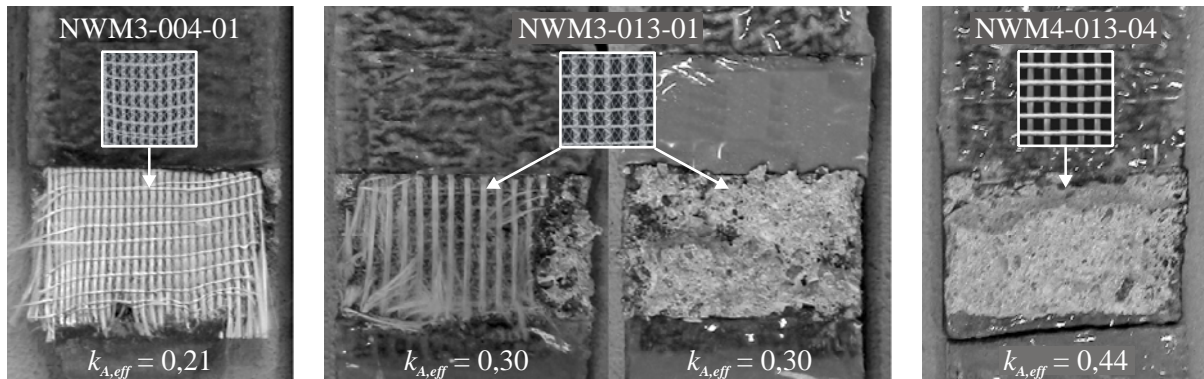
Umschlagen der Versagensart von der Delamination zum Altbetonbruch mit Erhöhung des wirksamen Flächenanteiles der Textilstruktur
